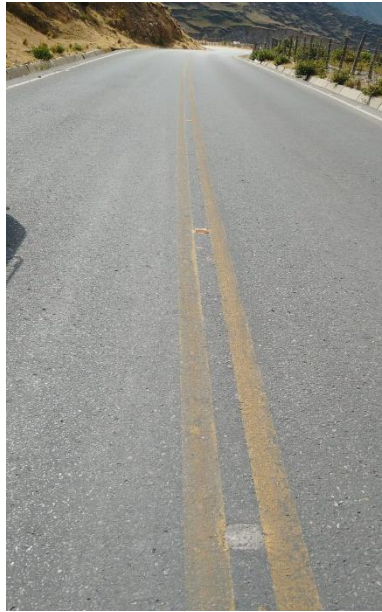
Pavimento sin tachas (Fuente: Propio)
